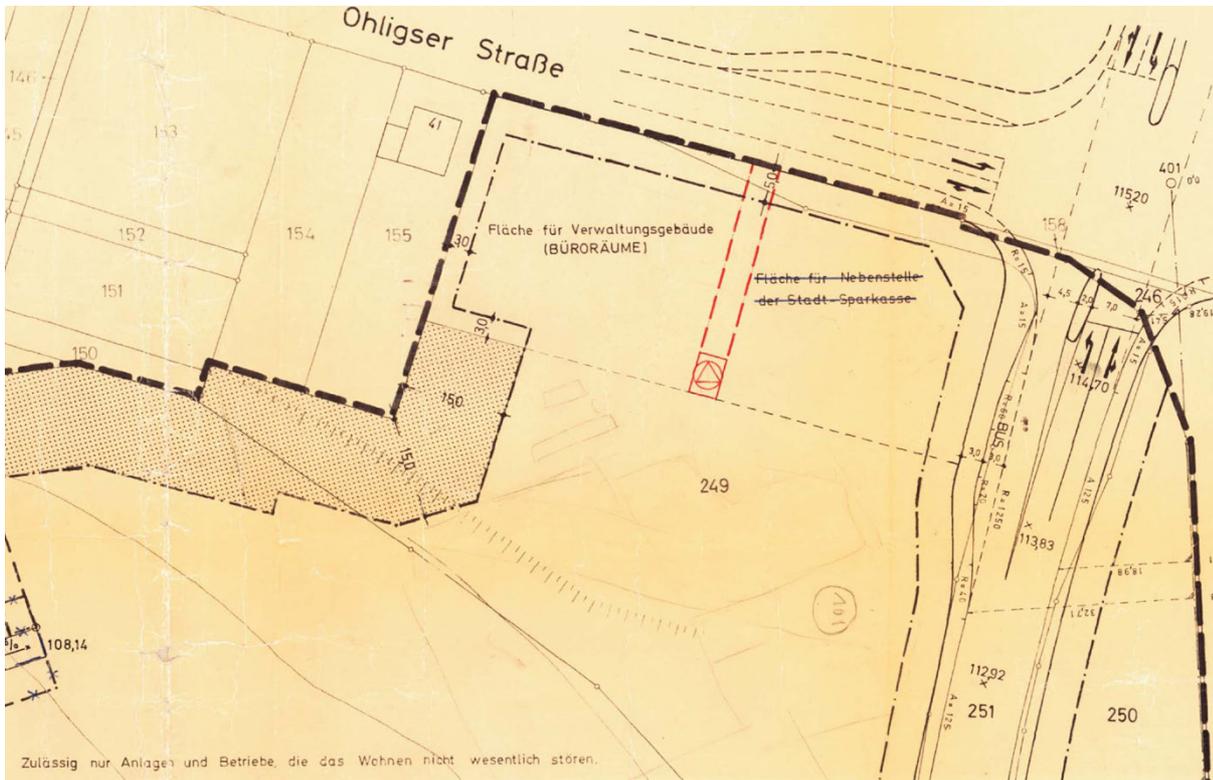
Bebauungsplan, Ausschnitt Plangebiet
